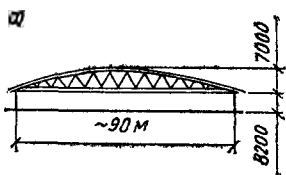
Замена верхнего пояса фермы металлической кровлей
